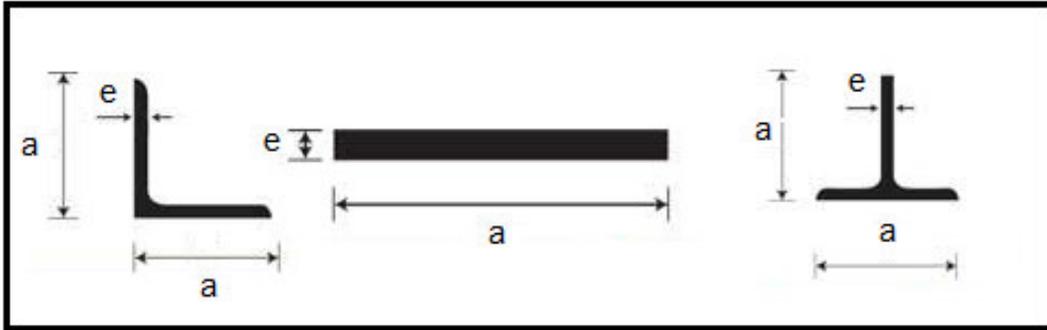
Sección transversal de los perfiles estructurales Navacero
